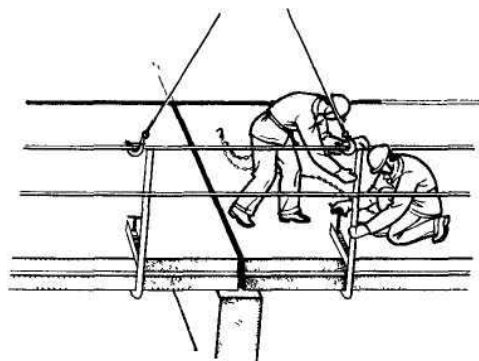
Укладка и анкеровка плиты перекрытия.
